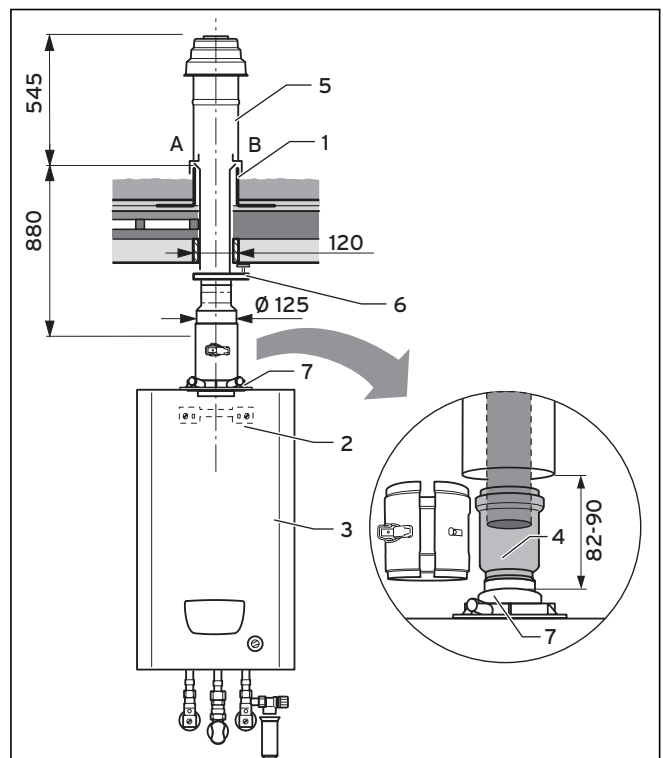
Montaje del aparato y de la salida en tejado plano
